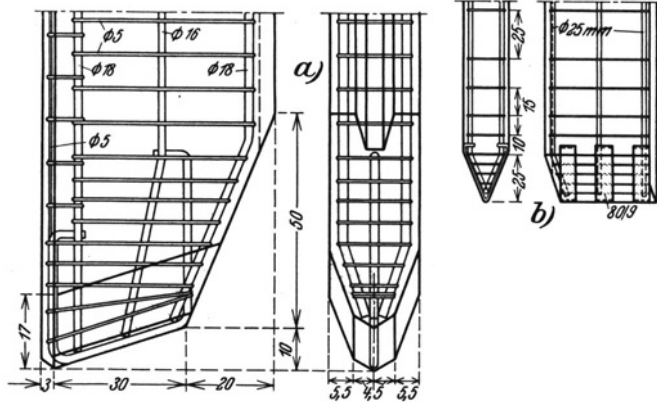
Ausbildung der Schneide von Eisenbetonspundbohlen. a) mit Rundeisenbewehrung (Dyckerhoff und Widmann), b) mit Flacheisenbewehrung (P. Holzmann).
